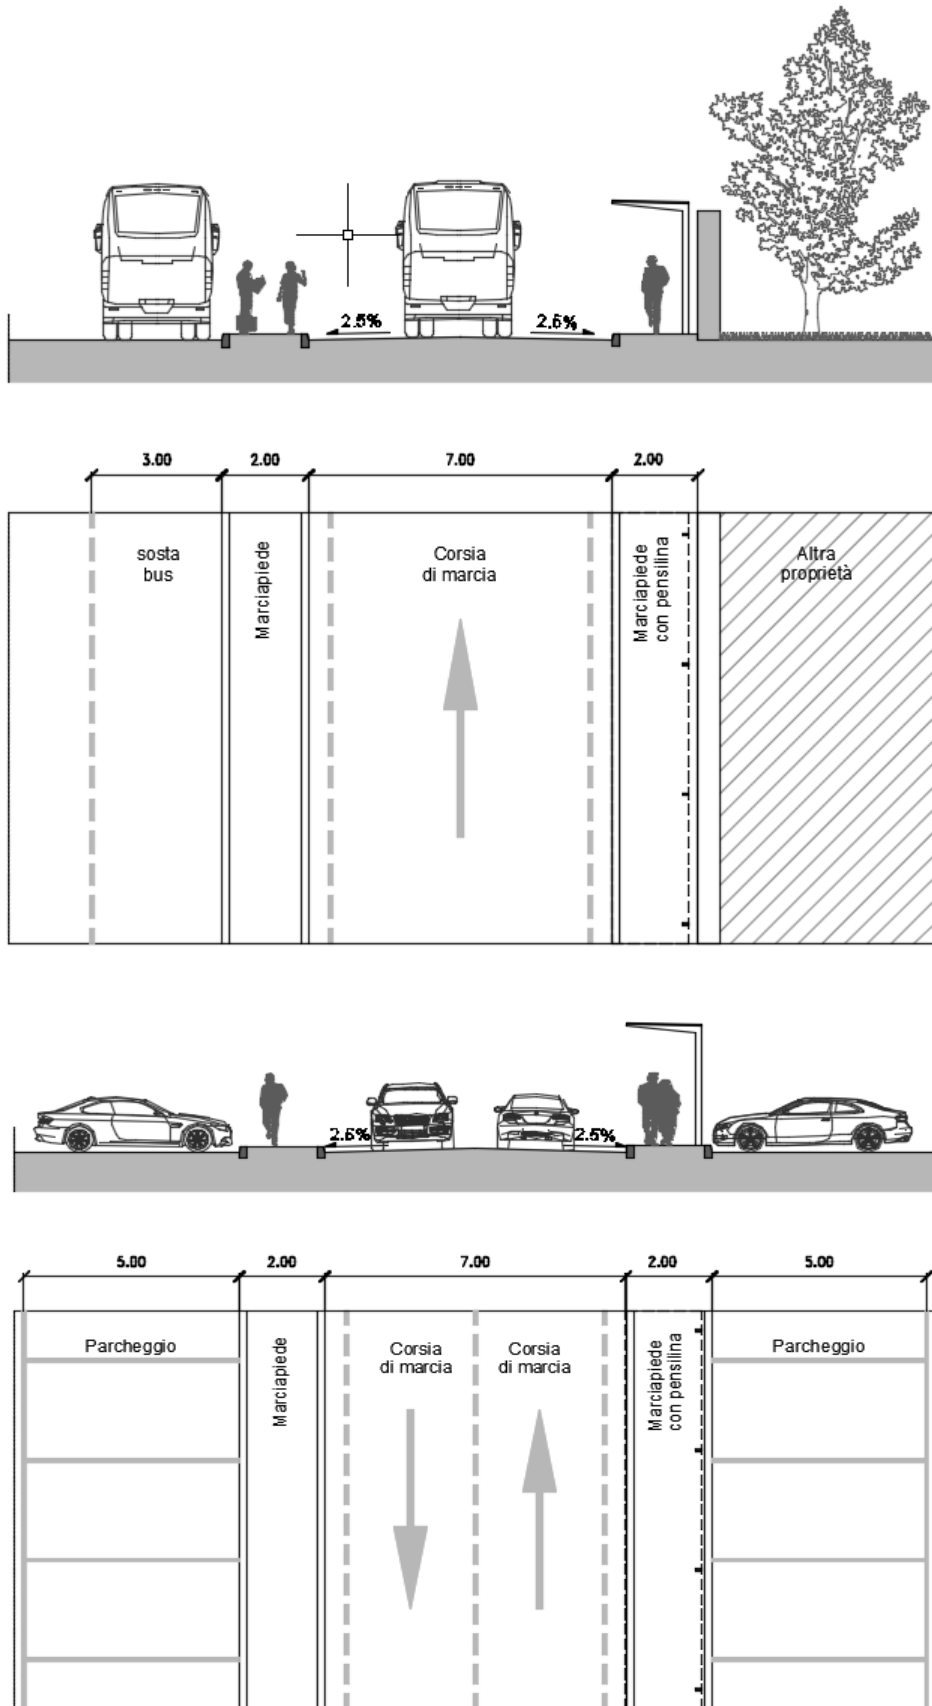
Riqualificazione della strada di distribuzione interna alle aree di sosta – sezione e dettaglio planimetrico. Elaborazione One Works.
